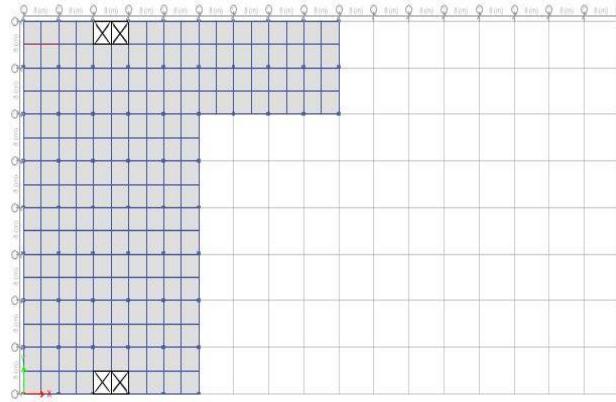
Denah Lantai 1 - Lantai 2 Model B1
